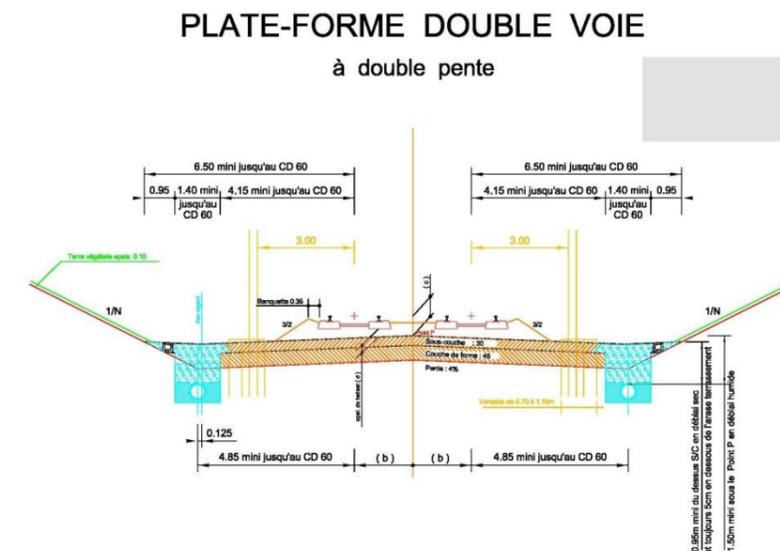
Profils en travers type en déblai avec collecteur drainant (CD)
